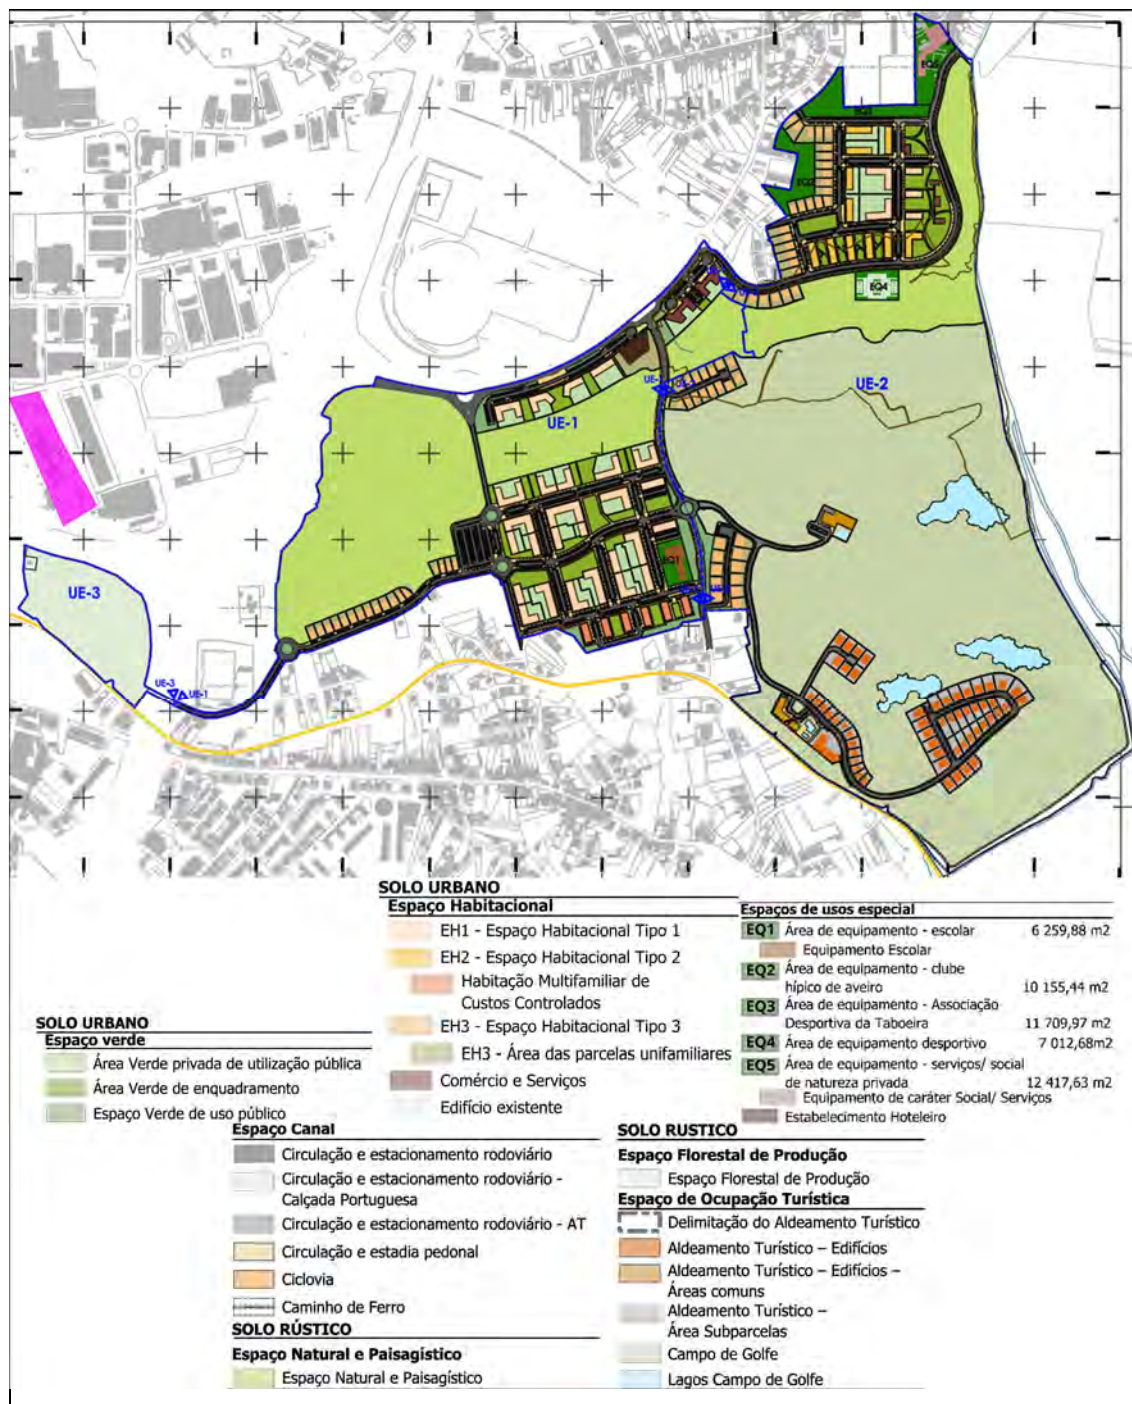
Planta de implantação e unidades de execução do PP-PDA.
